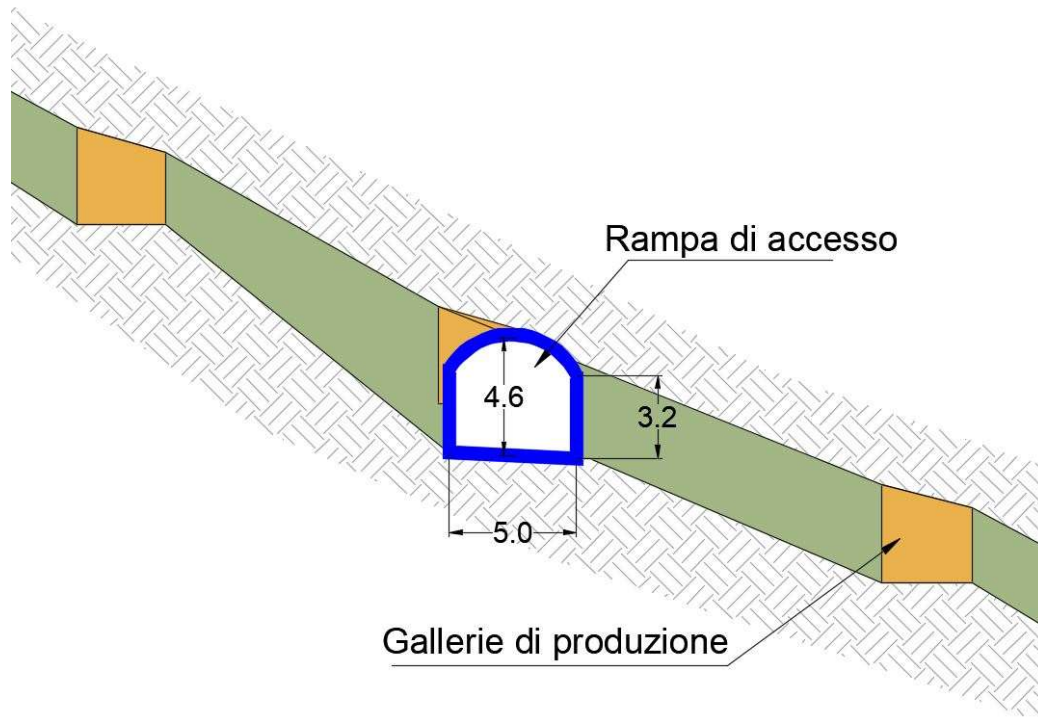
Particolare della sezione con giacimento, rampa e gallerie di tracciamento
